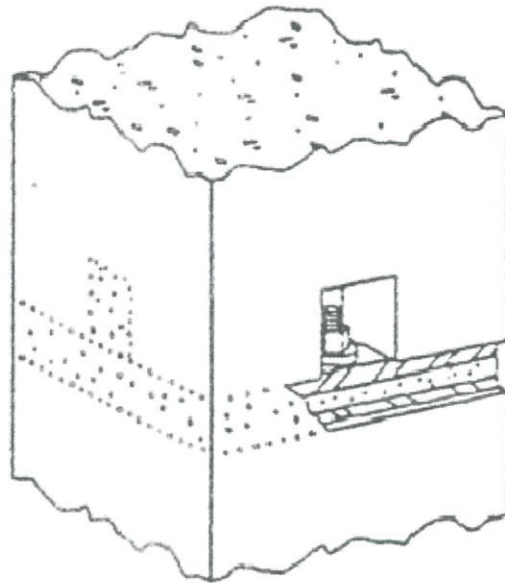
menunjukkan penyambungan tiang yang menggunakan ruang bolt pengikat. Tetulang utama tiang atau dowel yang menindih kepada tetulang tiang adalah dikimpal di atas plat dasar. Ruangan bolt pengikat tersebut adalah diletakkan pada sisi atau bucu.
